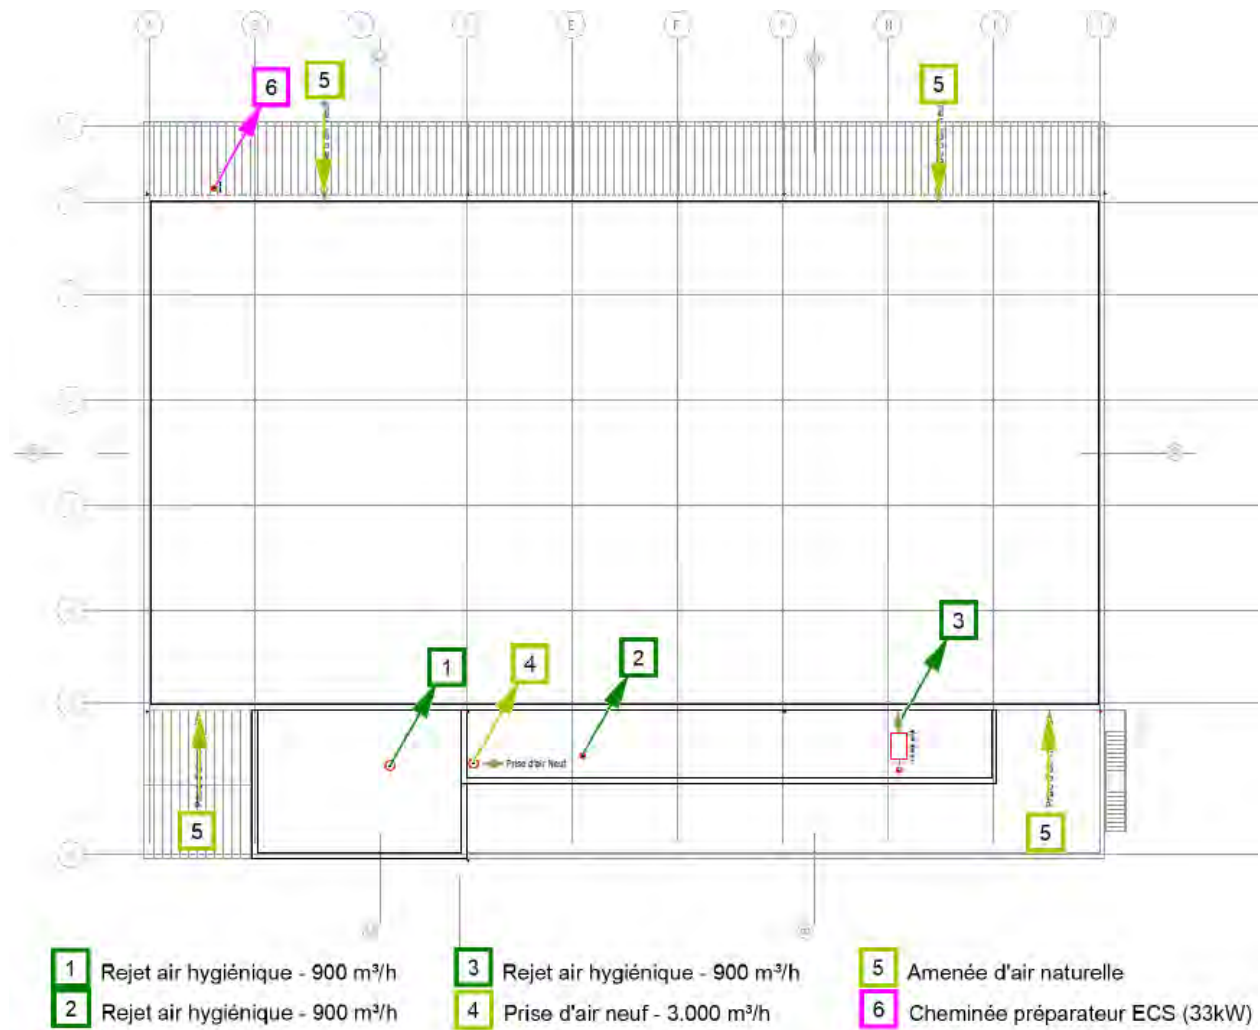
Localisation des prises d'air neuf en toiture, amenée naturelle d'air neuf en façade et des rejets d'air au niveau de la toiture du Hallio (MK Engineering, 2018)
